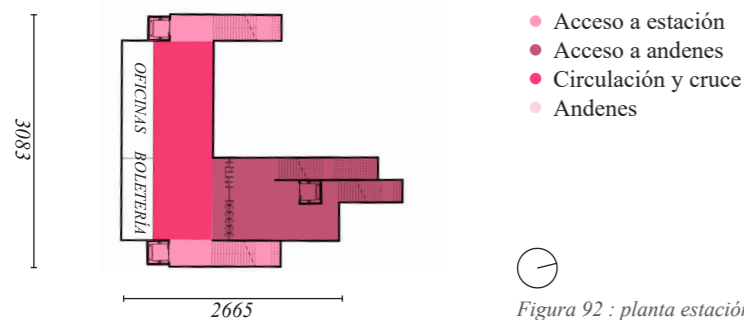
planta estación Pedro Aguirre Cerda | Fuente: elaboración propia
